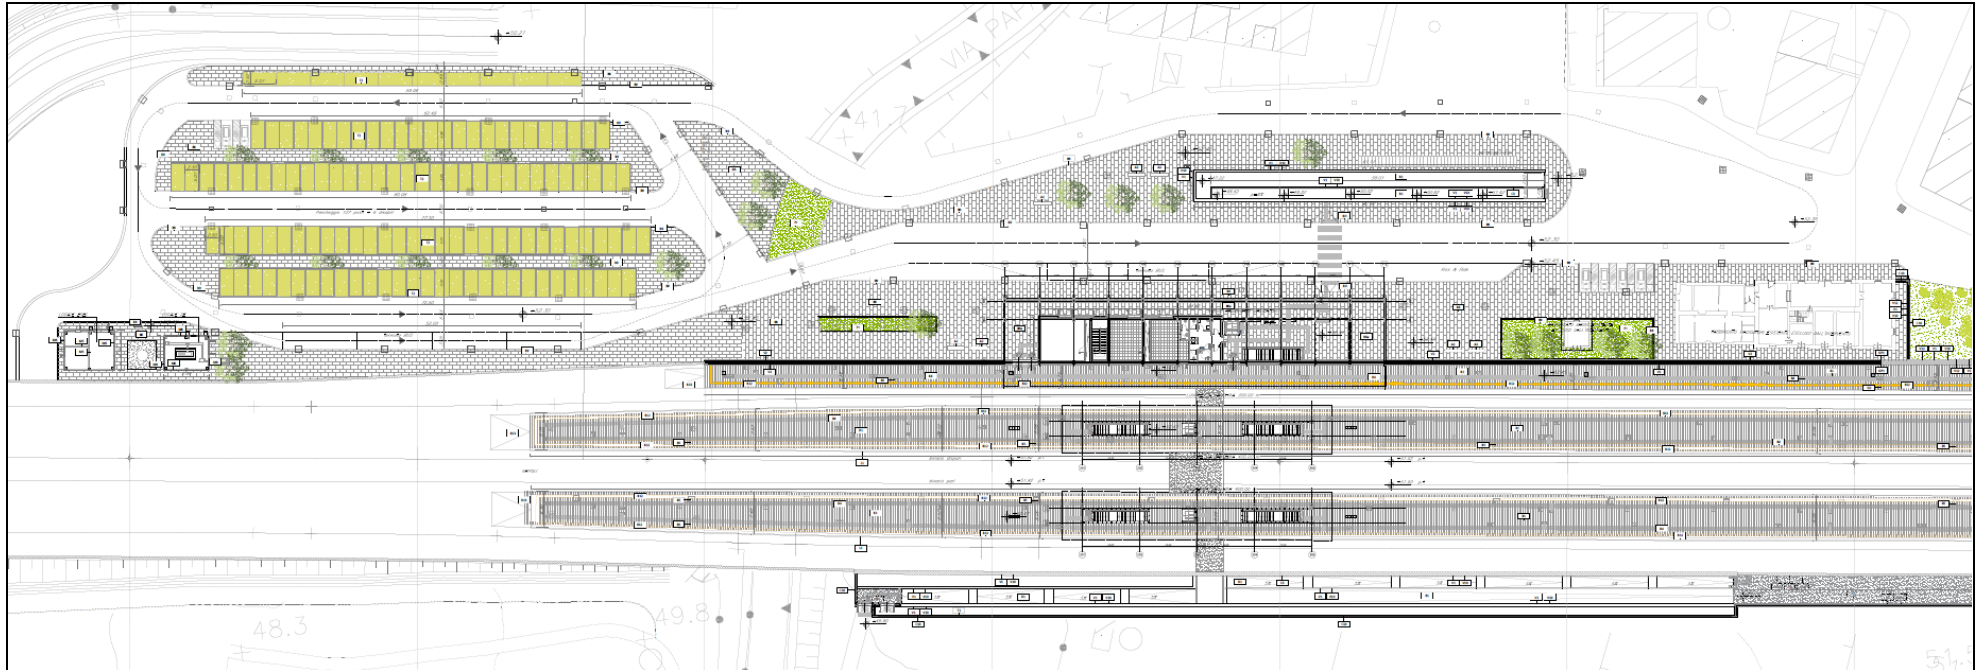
Stazione Telese - Pianta piano banchine (Rif.: [12], [13])
